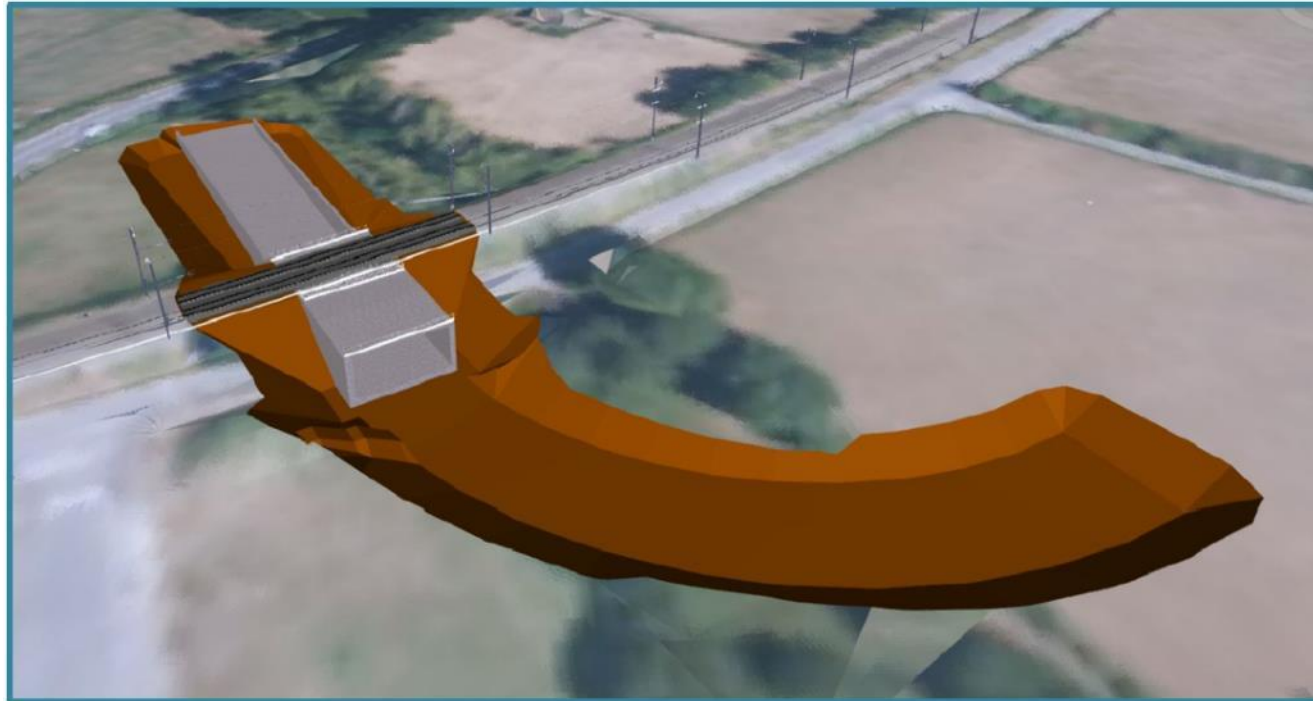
TERRASSEMENT POUR LA RAMPE SUD
